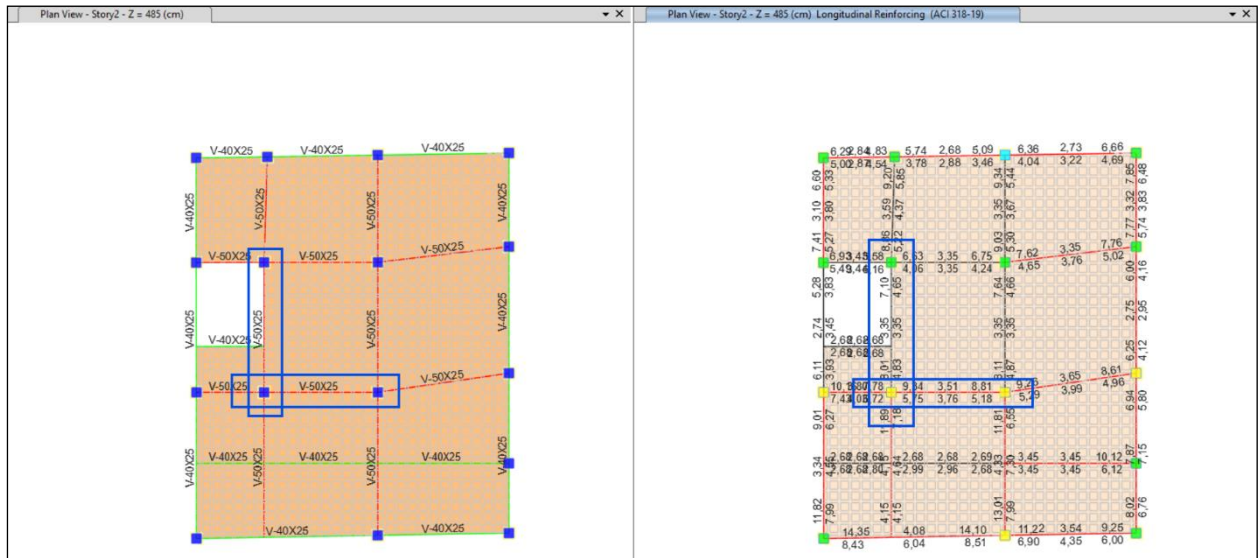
Acero a flexion en vigas de losa nivel 2, alternativa 1 [Autor]
